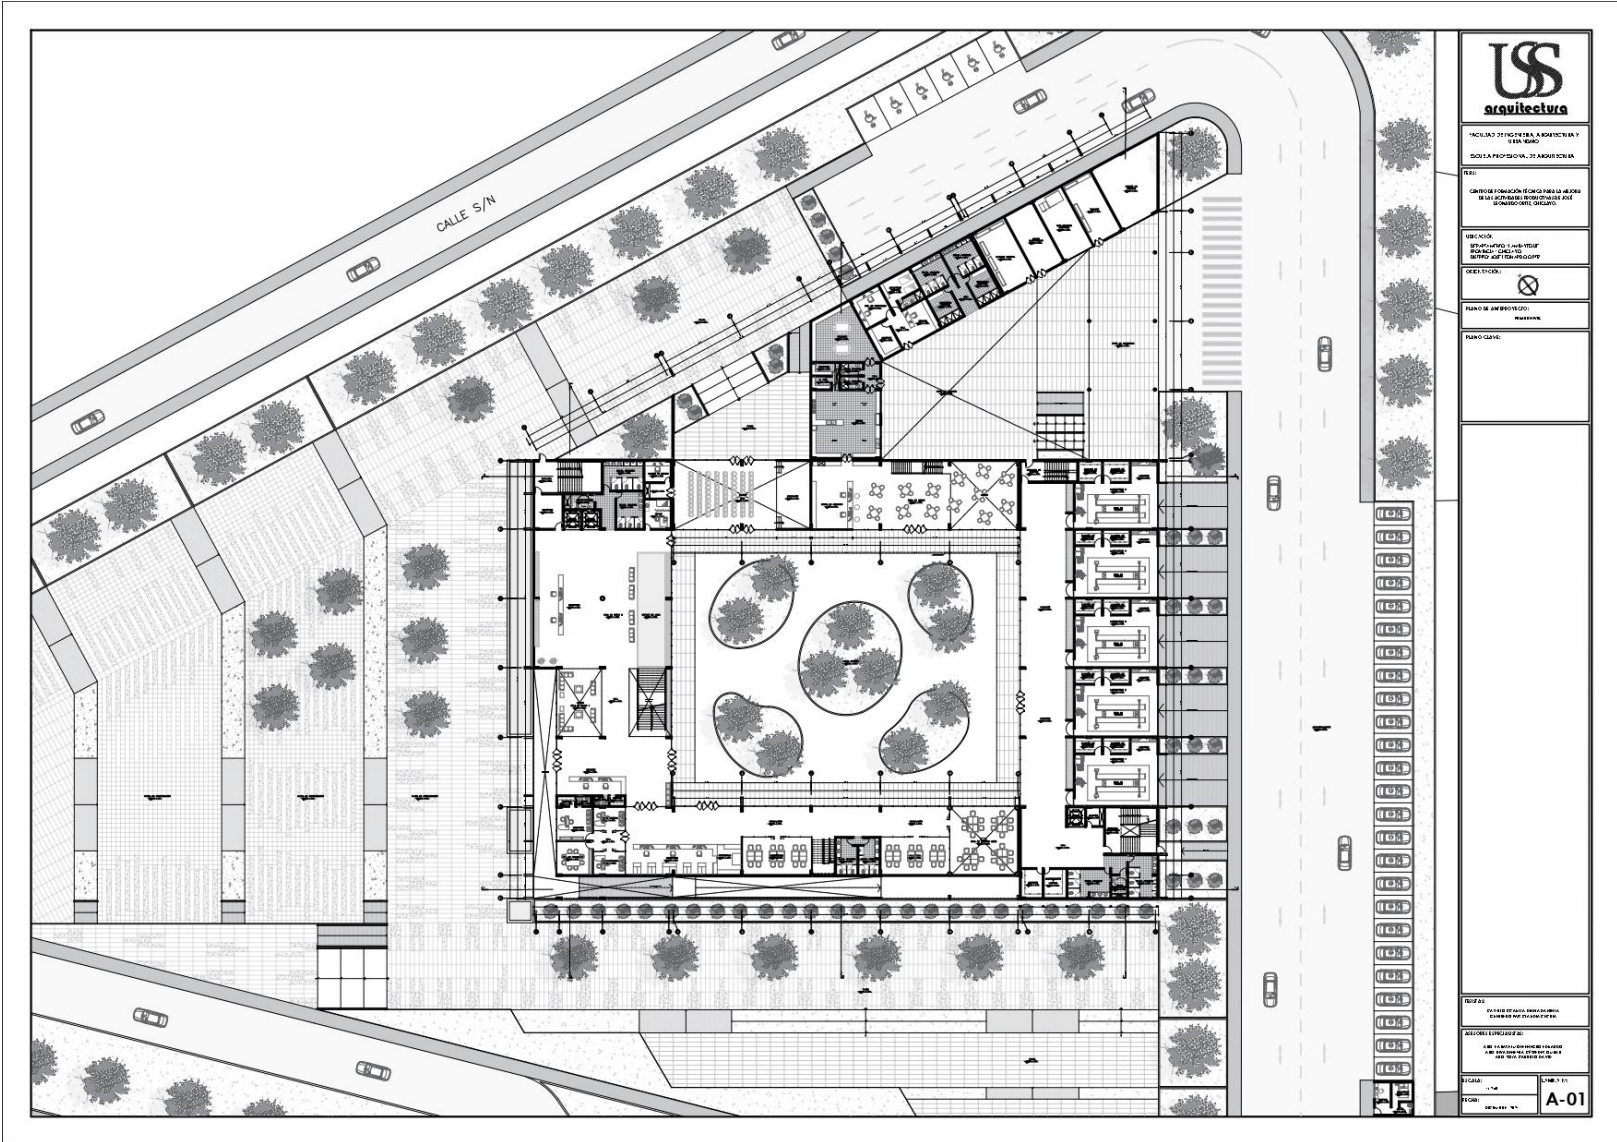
Planta arquitectónica - Primer Nivel. Elaboración propia
